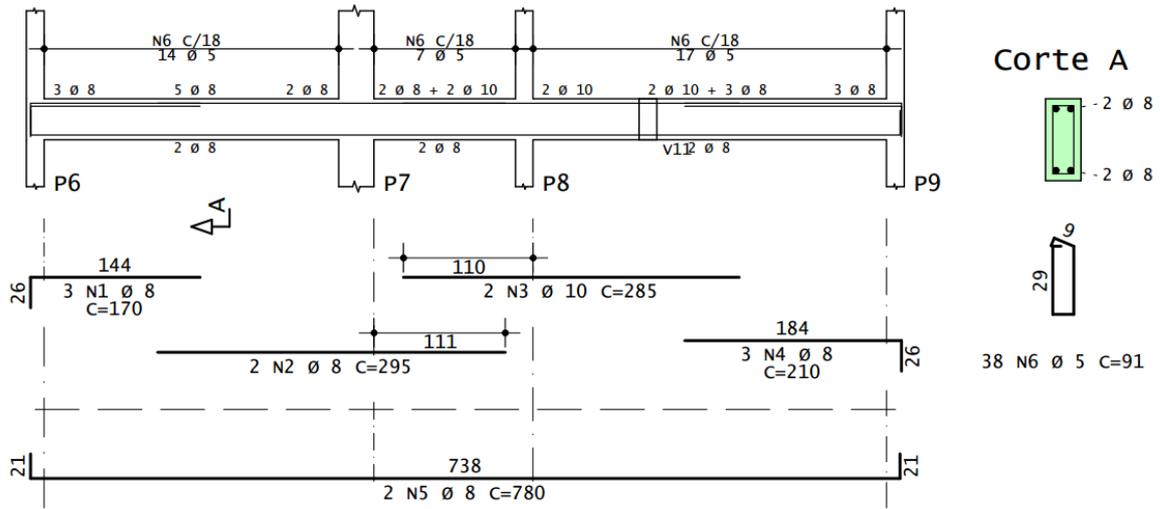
Armadura da viga baldrame V5 – pavimento térreo (nível 0,00)
